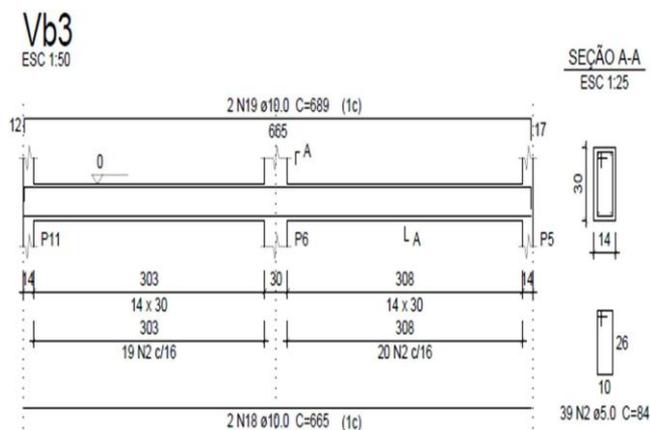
Dimensões da Viga Baldrame e detalhe da armadura long/trans. Vb3
